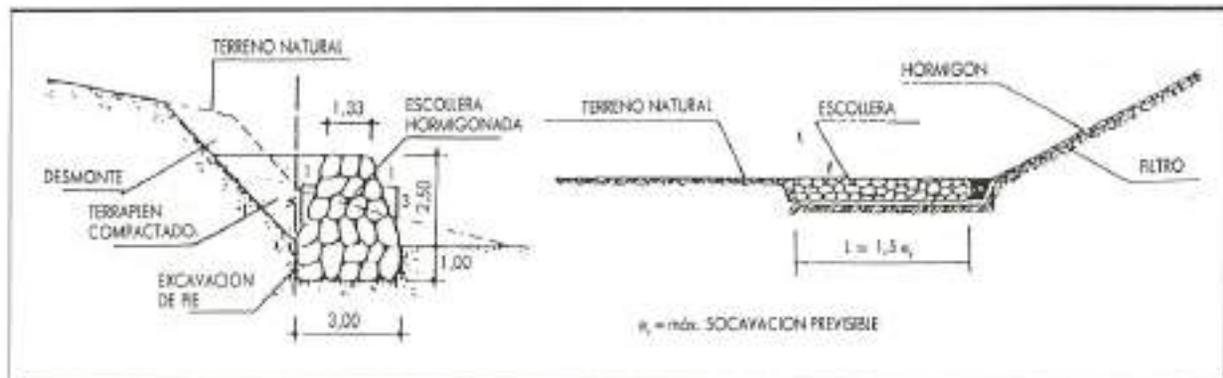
Protección de márgenes con escalera hormigonada y losas de hormigón.
